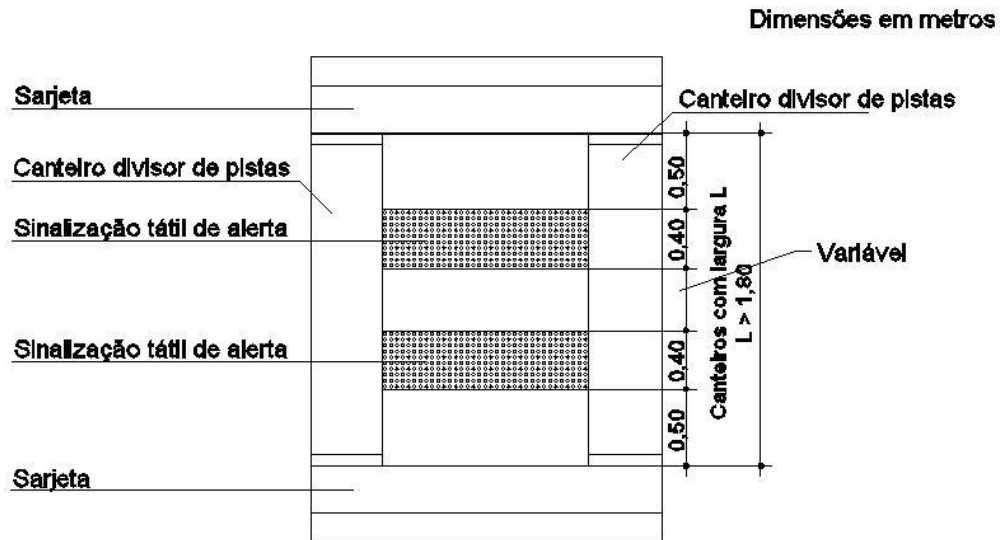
Rebaixamento de canteiro divisor de pistas $L > 1,80$ m
